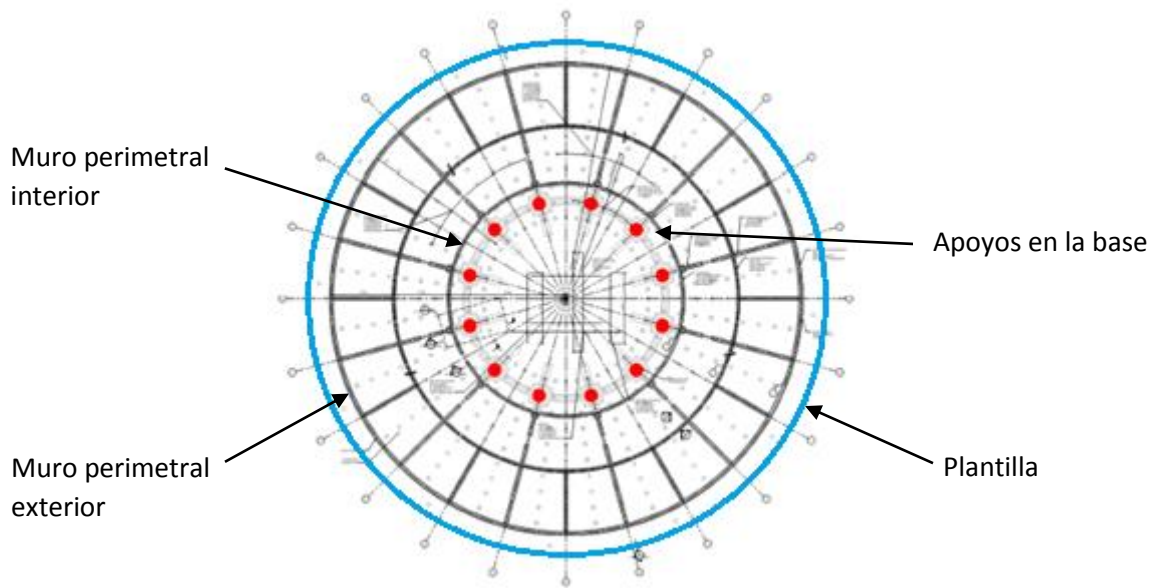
Vista en planta con las posiciones de los 12 apoyos en la base
